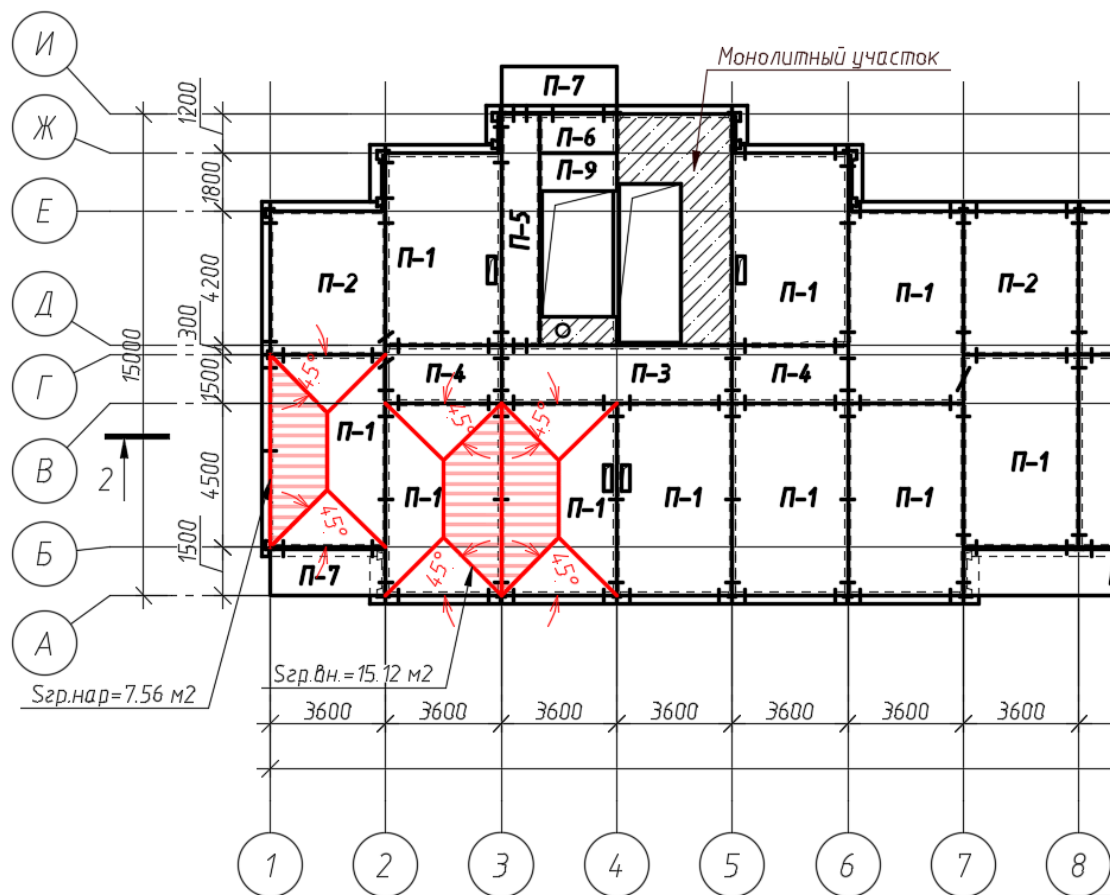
Определение грузовой площади от плит перекрытия и покрытия
